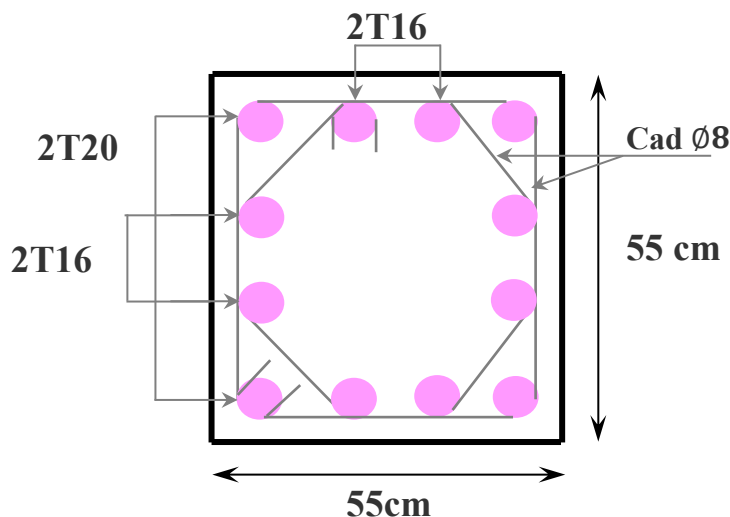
Schéma de ferraillage des poteaux 55x55.
